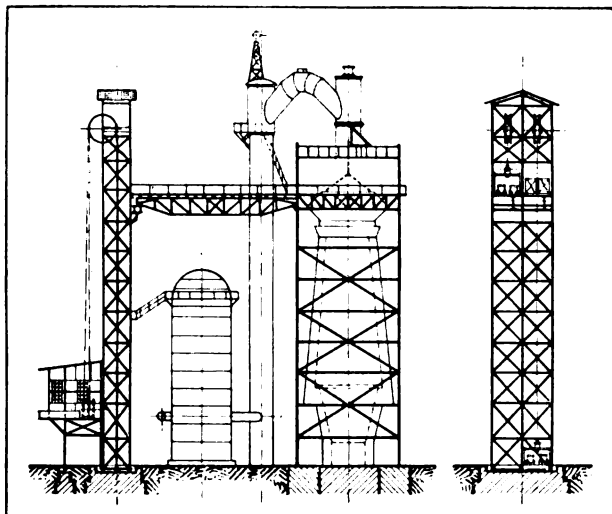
Senkrechter Aufzug mit Handbegichtung.
